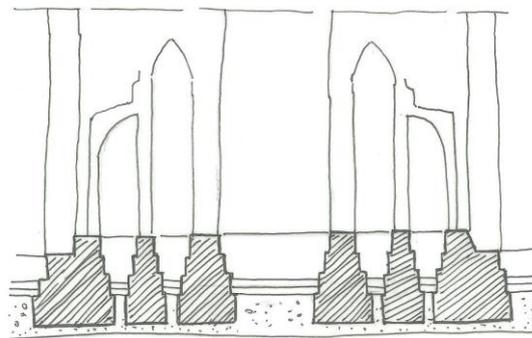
Cimiento de la cabecera de la Catedral de Beauvais. 1225 d.C.
